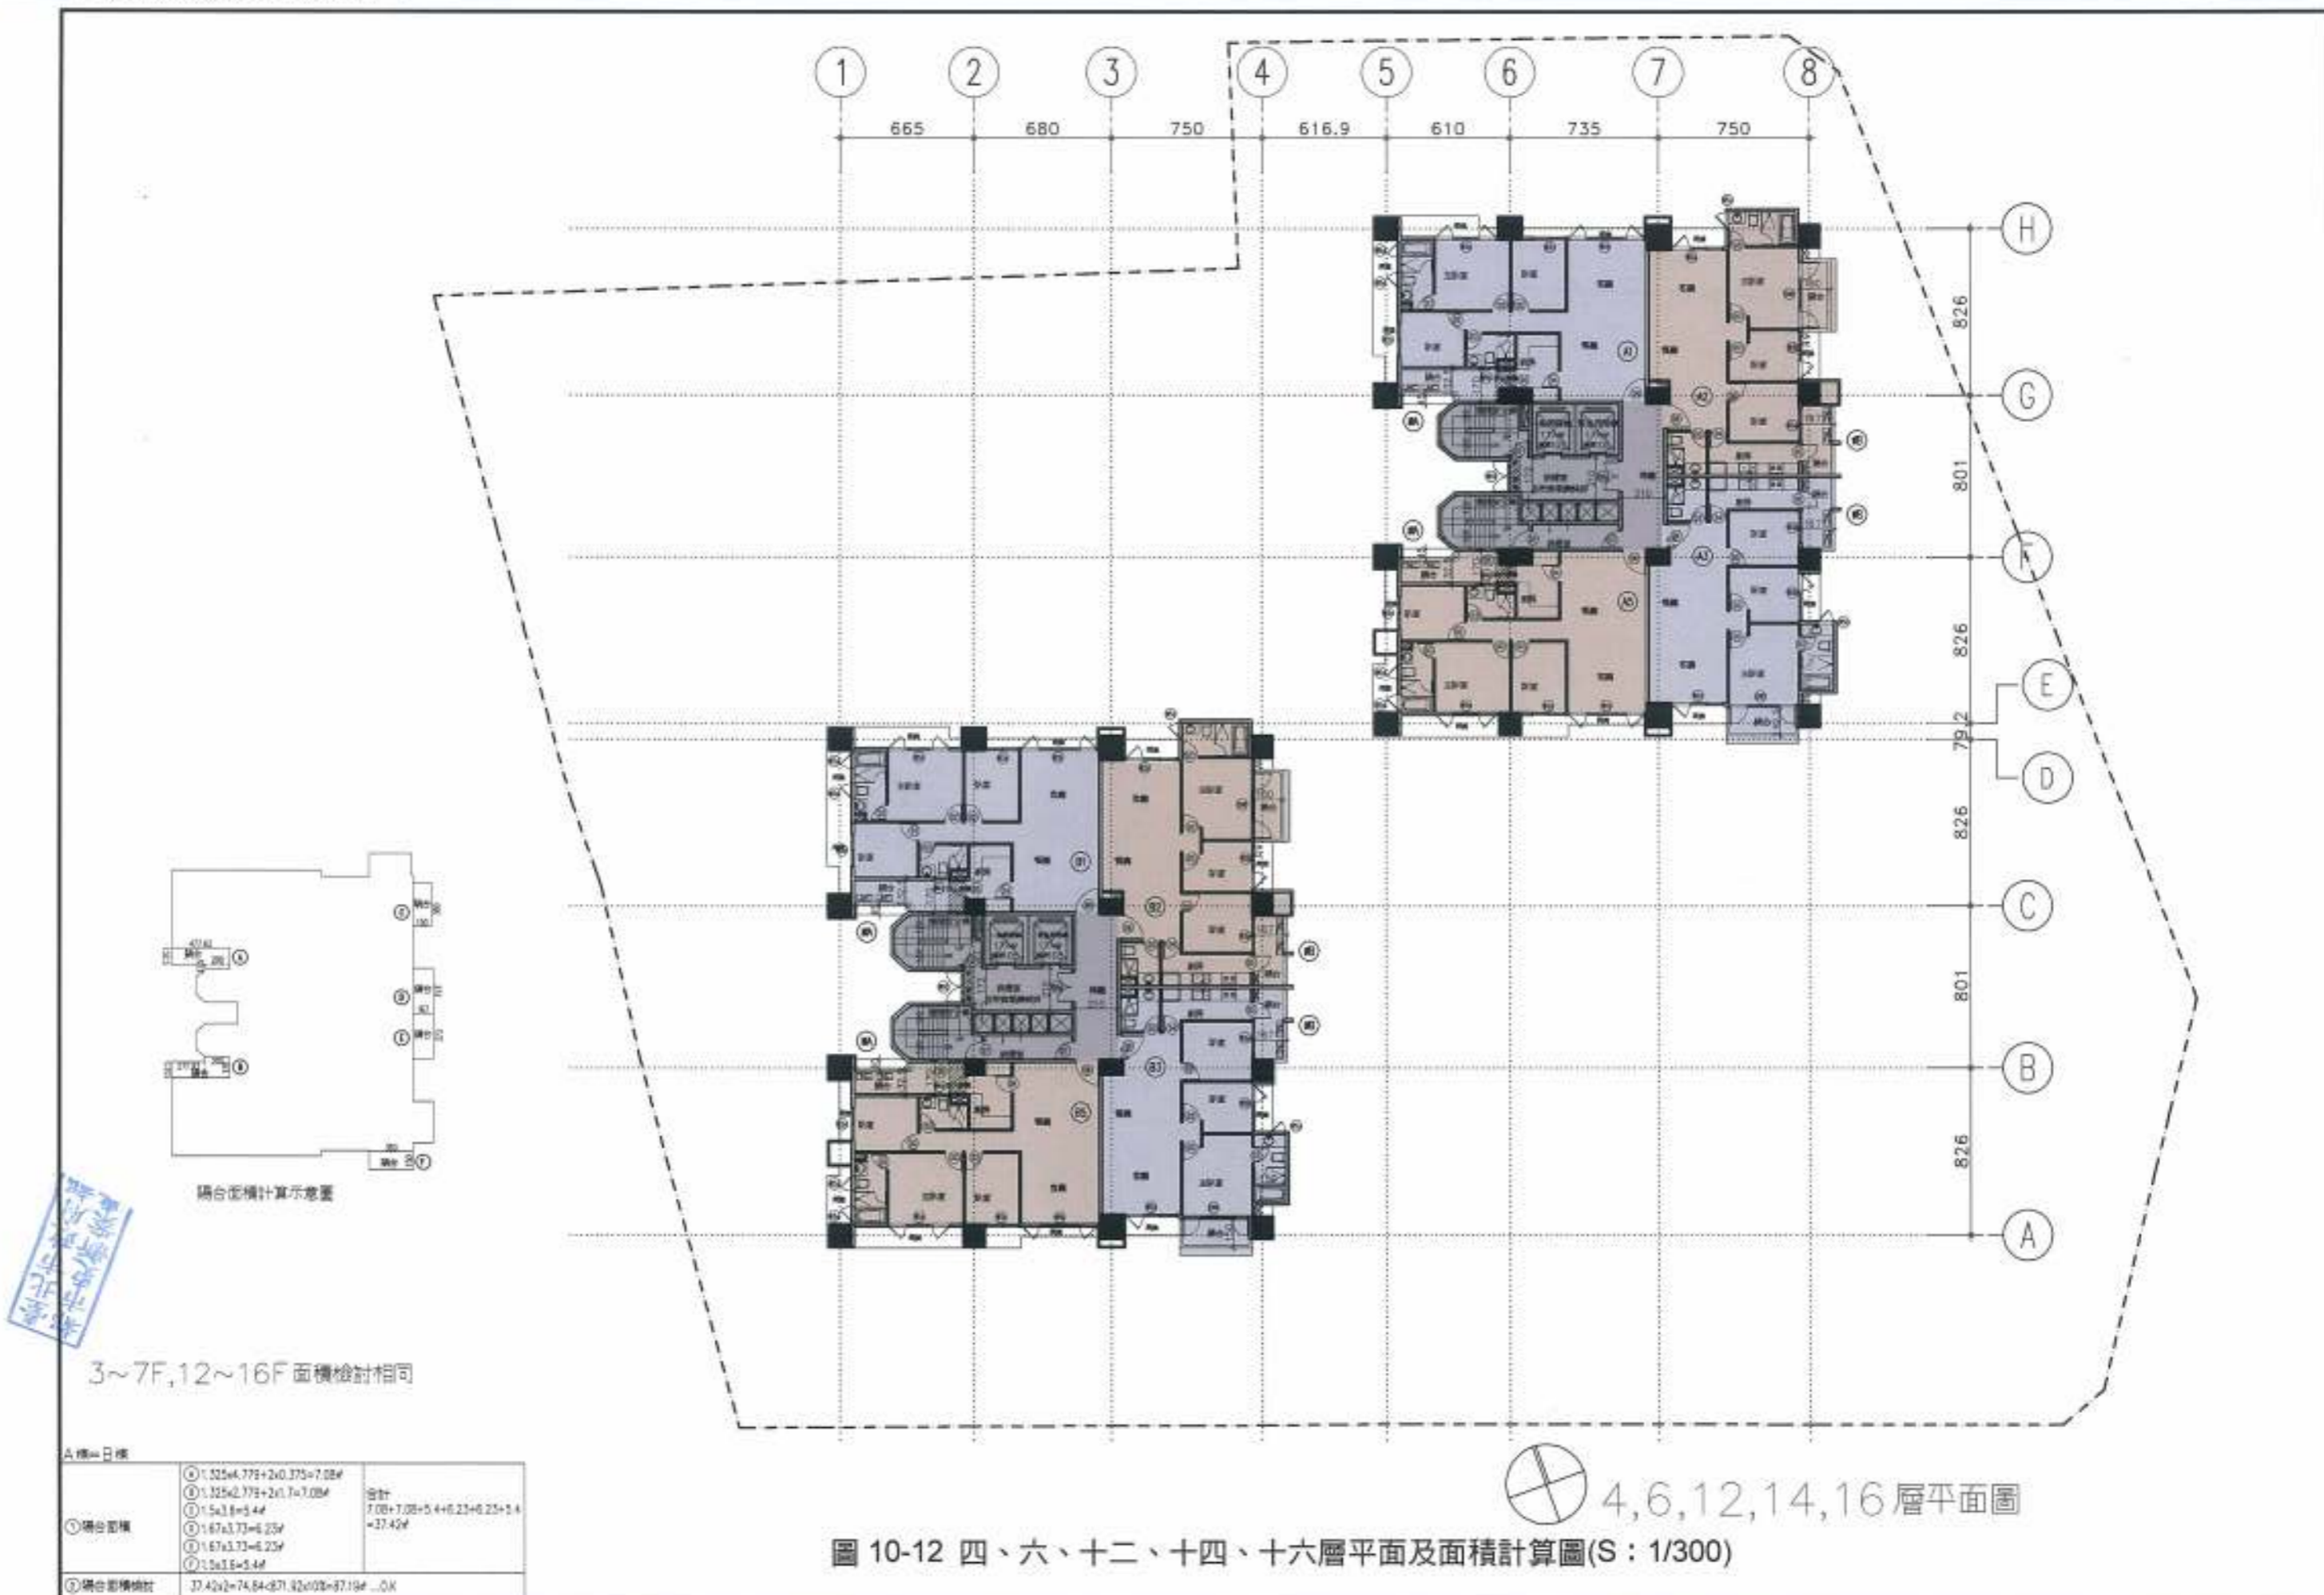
四、六、十二、十四、十六層平面及面積計算圖(S : 1/300)
